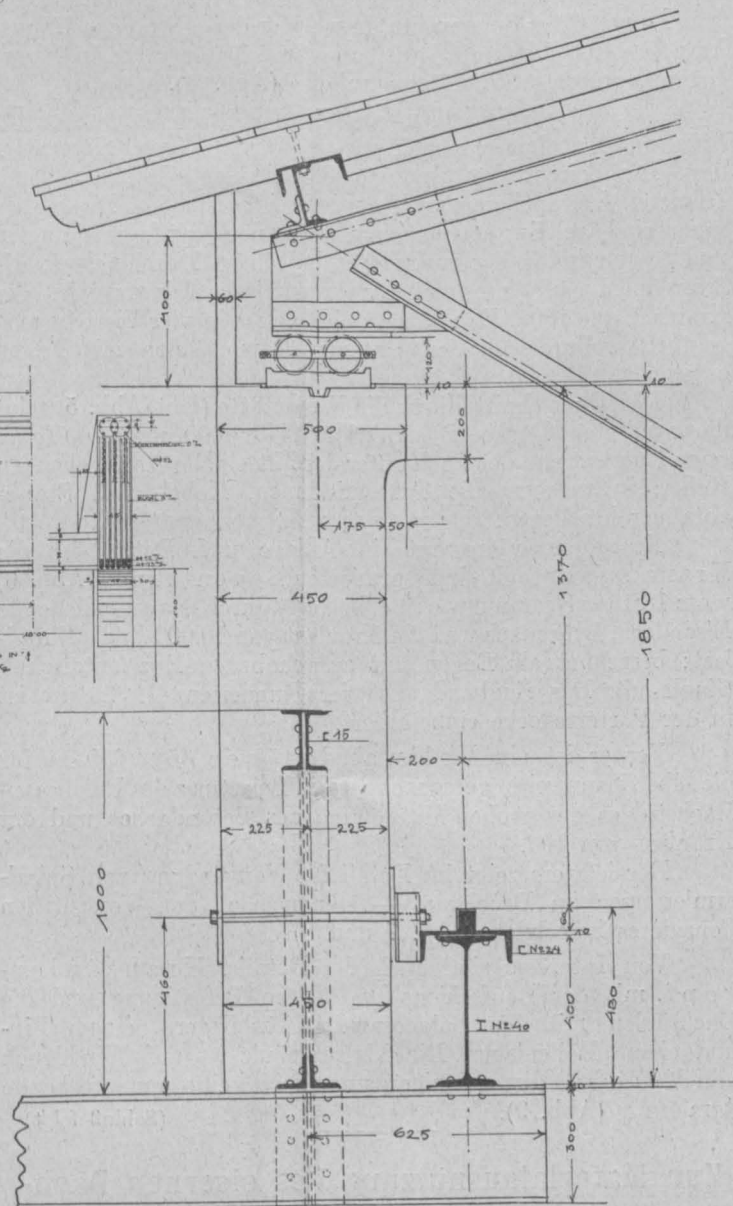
Holzbearbeitungswerkstätte Nesselsdorf, Kranfahrt mit Vollwandträger, Querschnitt mit Detail von Kran- und Dachauflager
